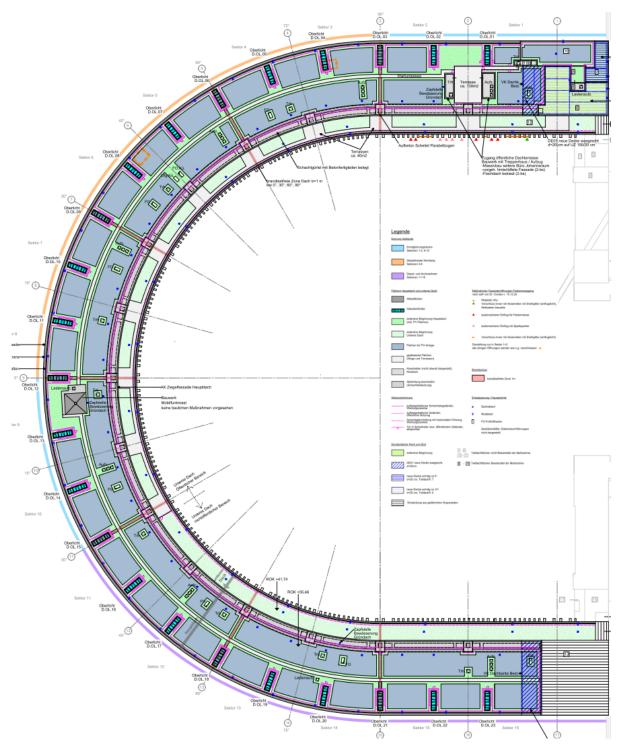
Dachaufsicht Hauptdach und unteres Dach (Kolonnadenebene)
